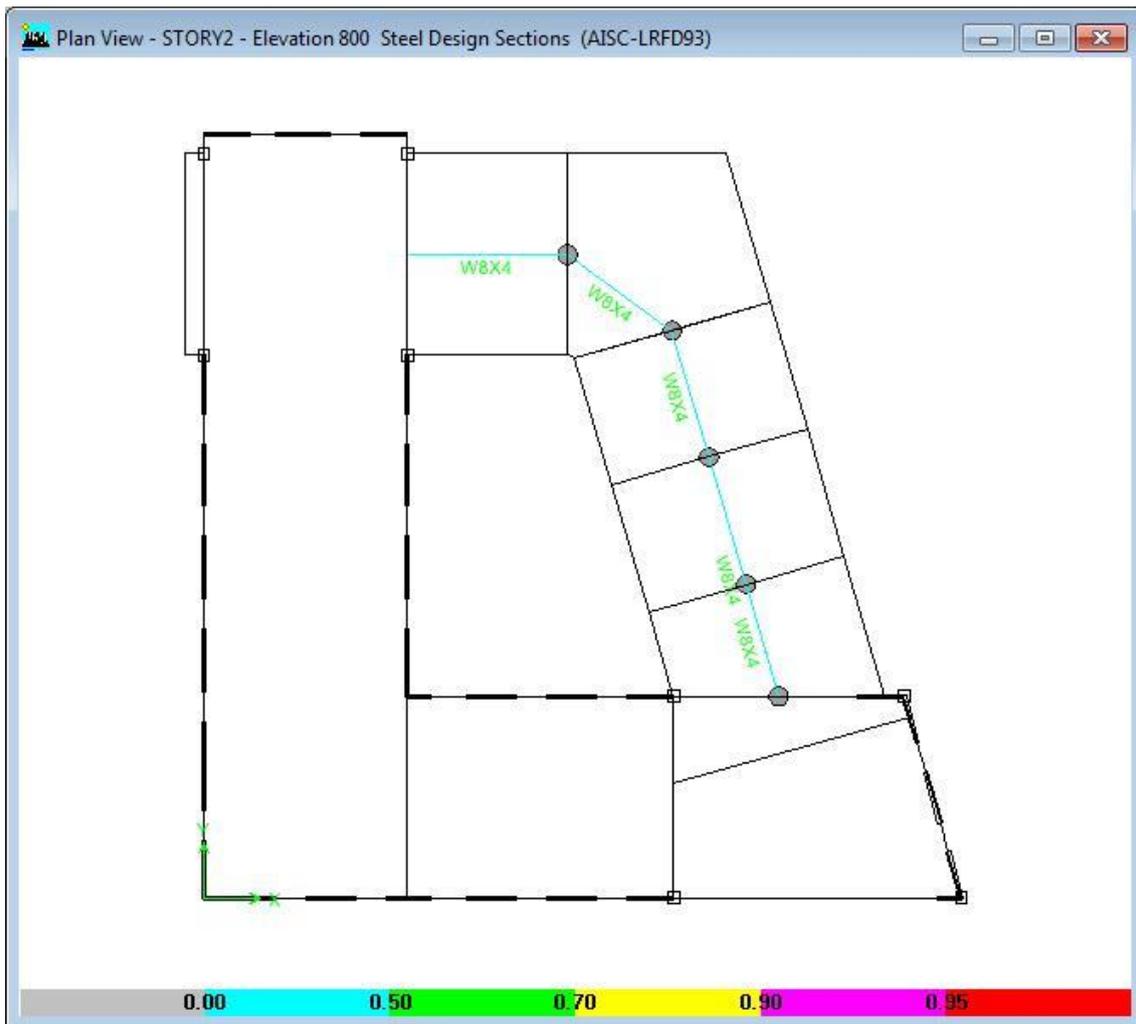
Vista en planta del arriostamiento de las columnas circulares de hormigón con vigas metálicas W8"x4".
